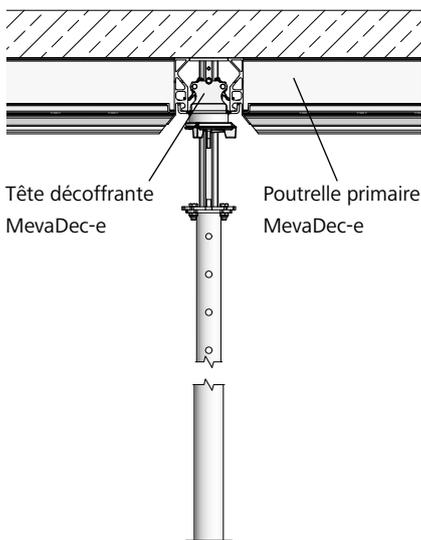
Méthode à poutrelles primaires et panneaux en travée
